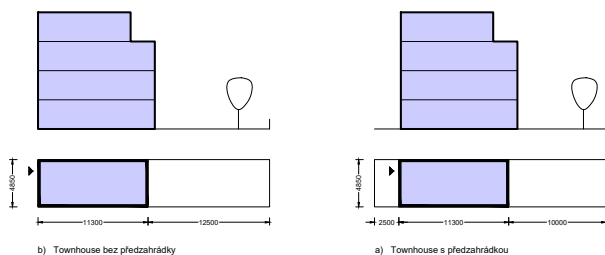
Hloubka townhousu (Zdroj: autor Erik Petrus)
